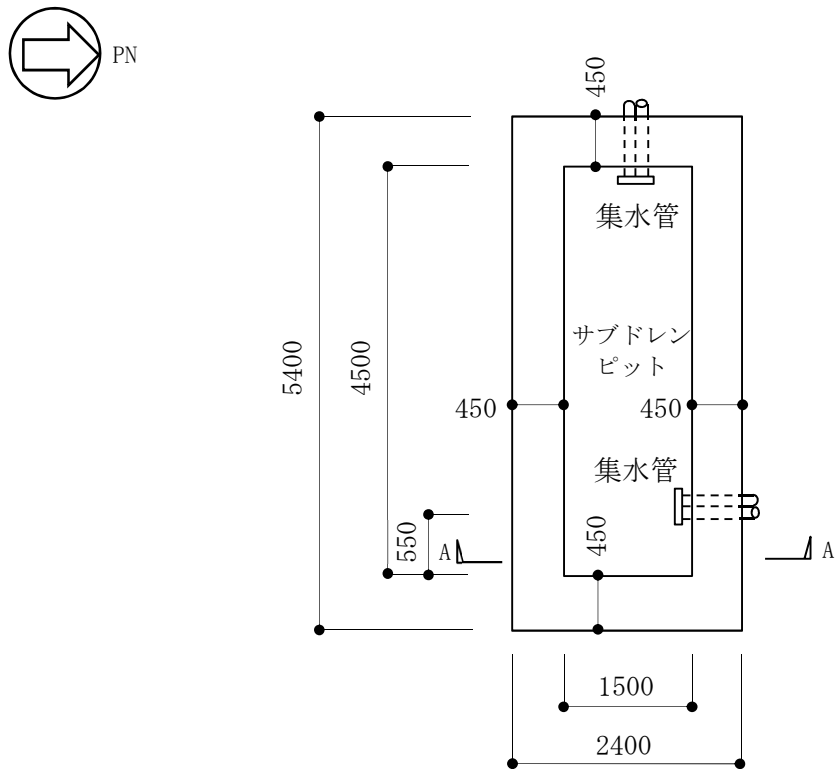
原子炉建屋サブドレンピットの概略平面図 (T.M.S.L. -15.20m) (単位 : mm)
